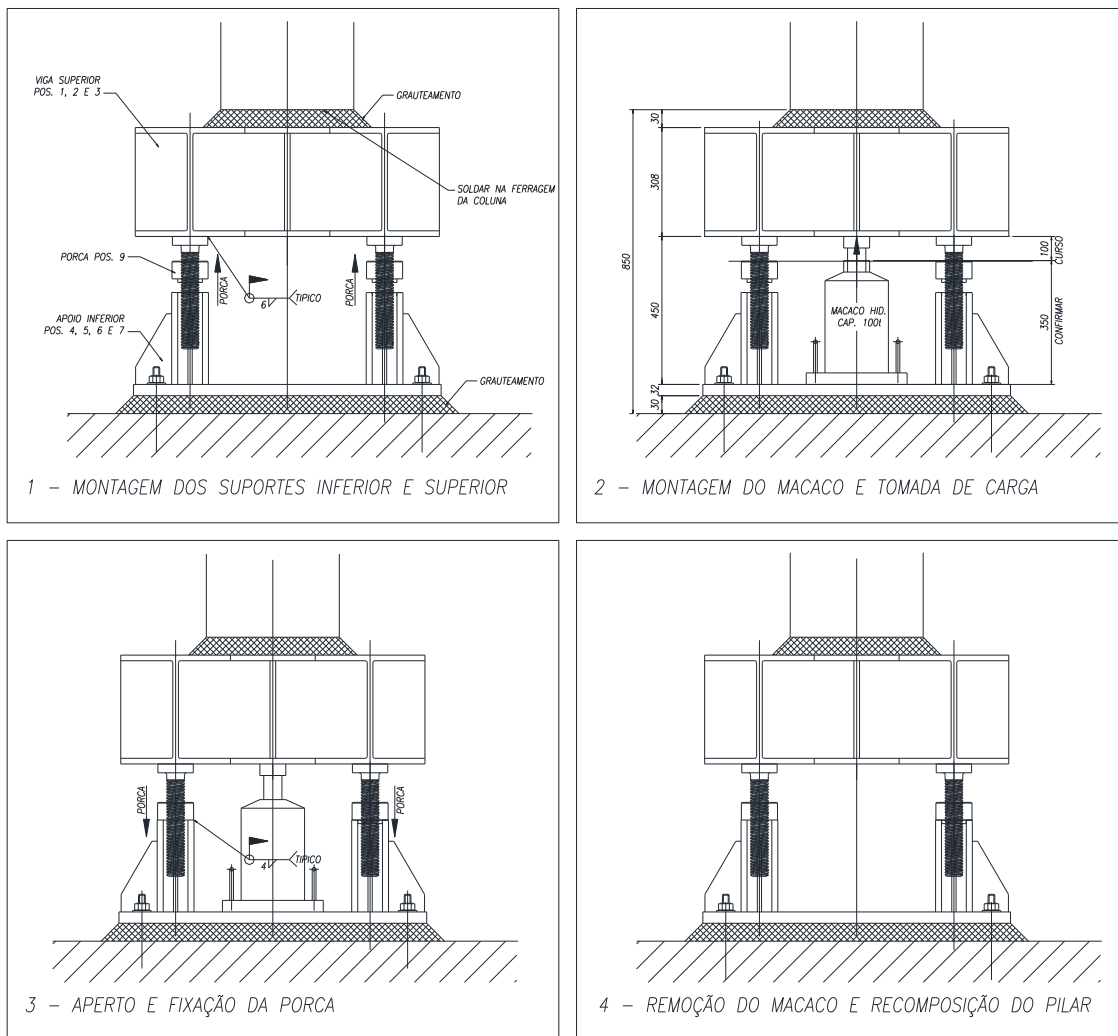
Projeto do aparato de apoio e tensionamento do pilar
